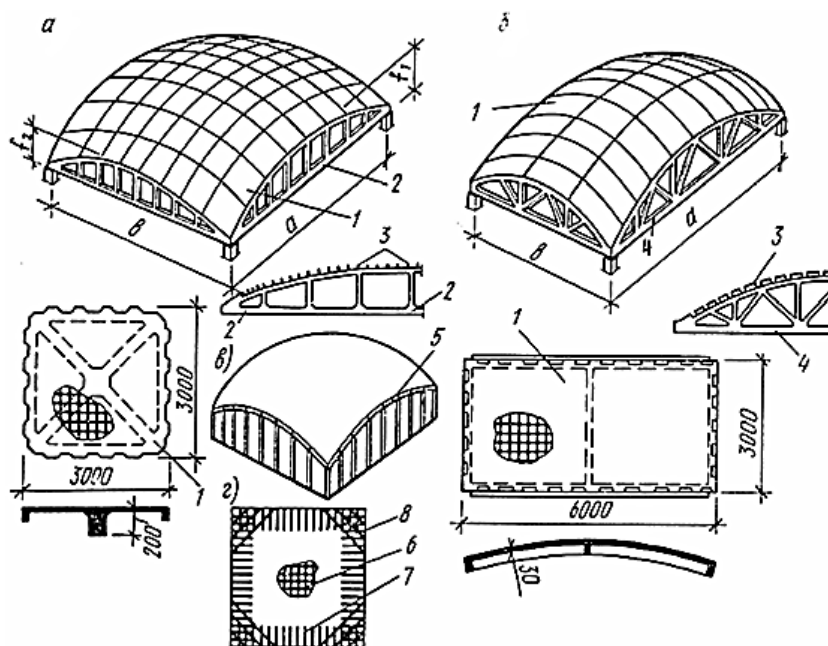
Конструктивные решения пологих сборных оболочек положительной гауссовой кривизны на прямоугольном плане (а — в); схема армирования монолитной оболочки (г): 1 — сборные плиты оболочки; 2 — диафрагма-арка; 3 — выпуски арматуры; 4 — диафрагма-ферма; 5 — контурный брус; 6 — конструктивная арматура; 7 — арматура, рассчитываемая на краевой изгибающий момент; 8 — угловая растянутая арматура
